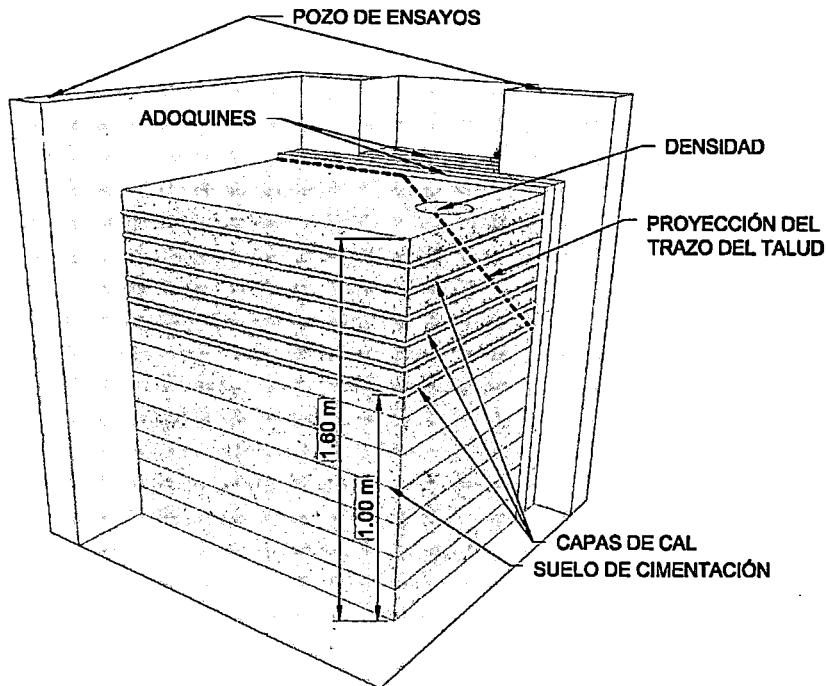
Vista en tres dimensiones del ensayo TSR2 N°2
